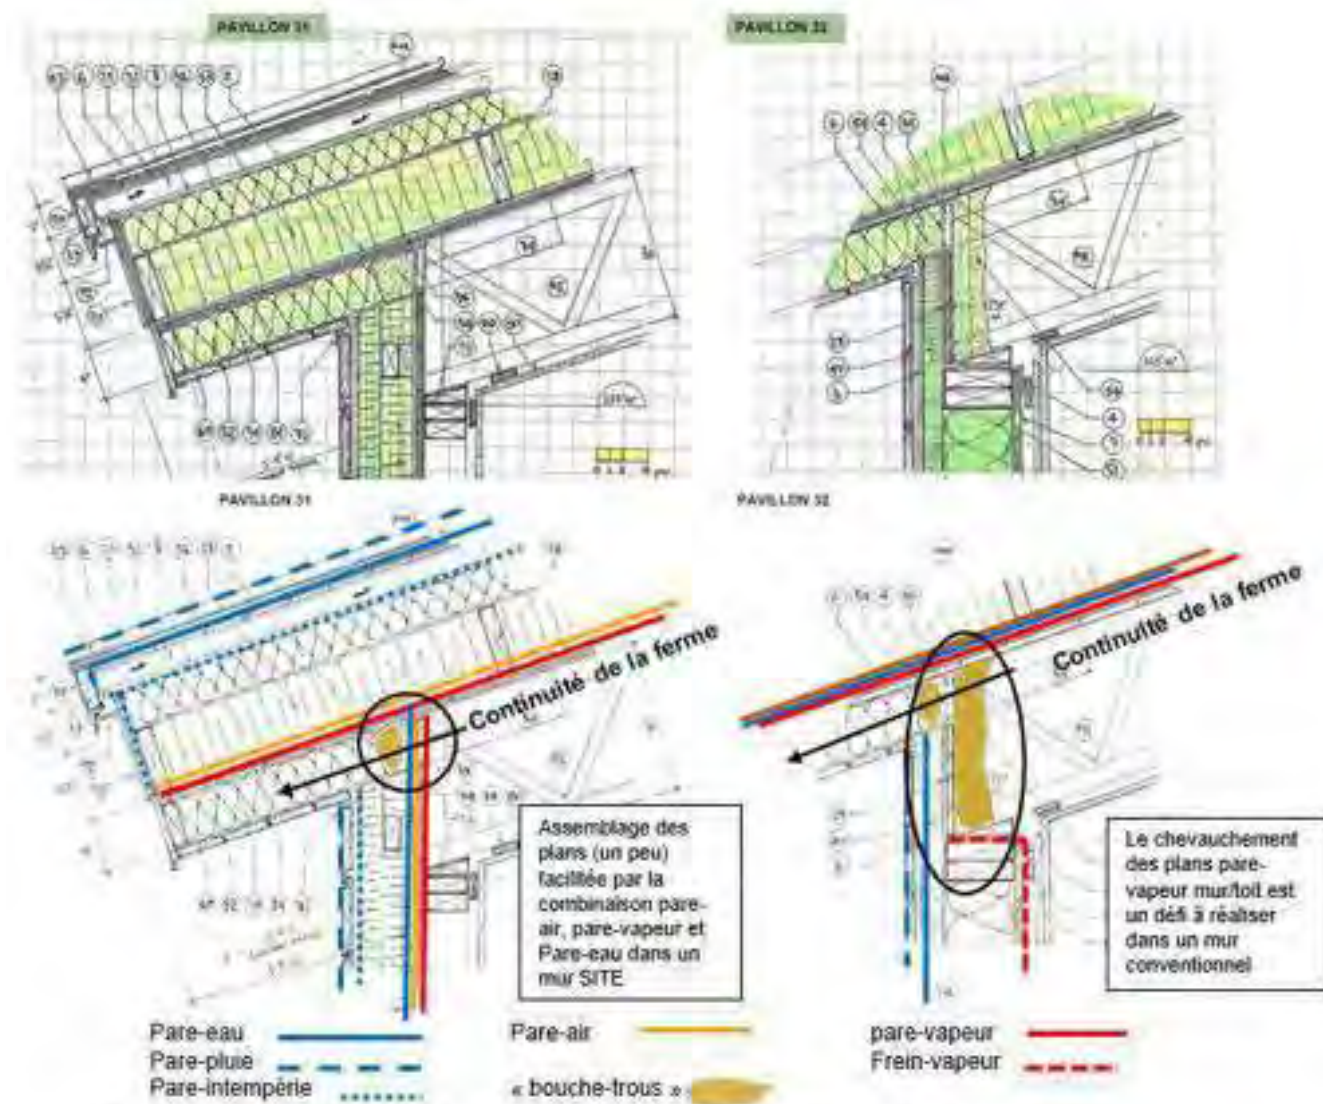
Positionnement des plans d'étanchéité sur un détail typique et problèmes aux jonctions
